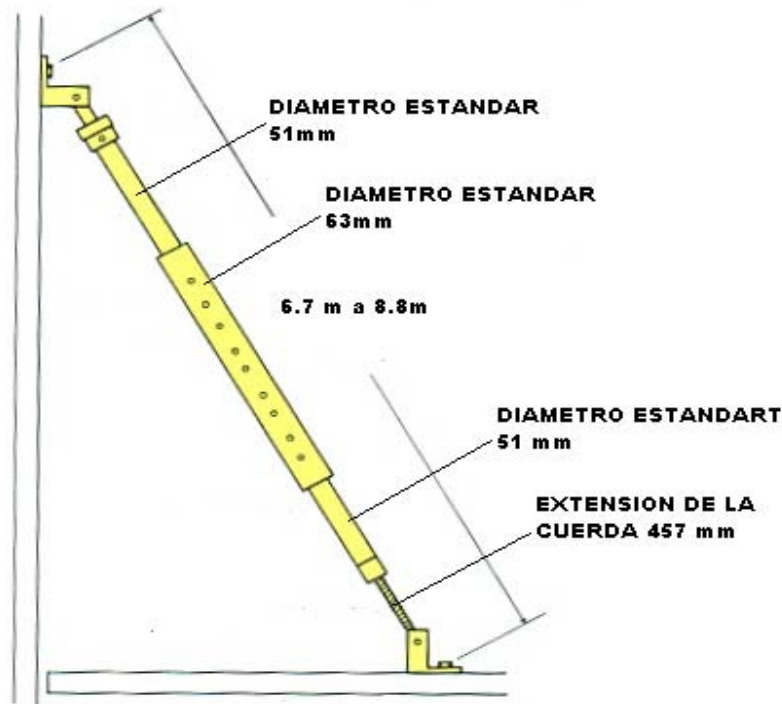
a Tubo telescópico con alcancé de 6 a 8 m.
